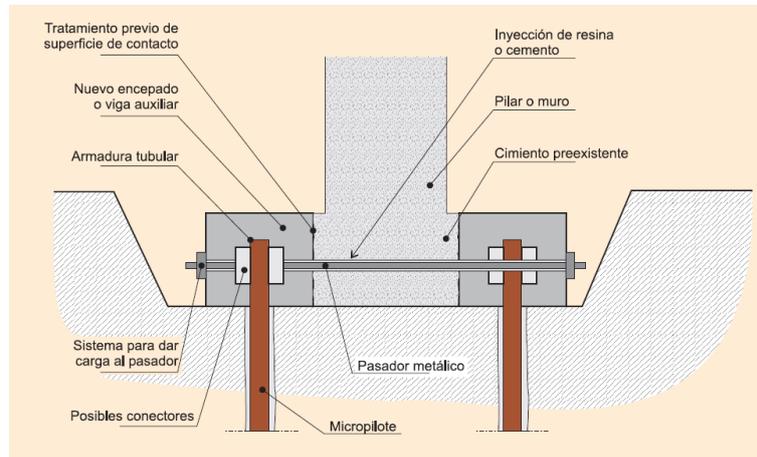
EJEMPLO DE CONEXIÓN DE UN NUEVO ENCEPADO QUE SE CONECTA A SU VEZ A UNA CIMENTACIÓN PREEXISTENTE
